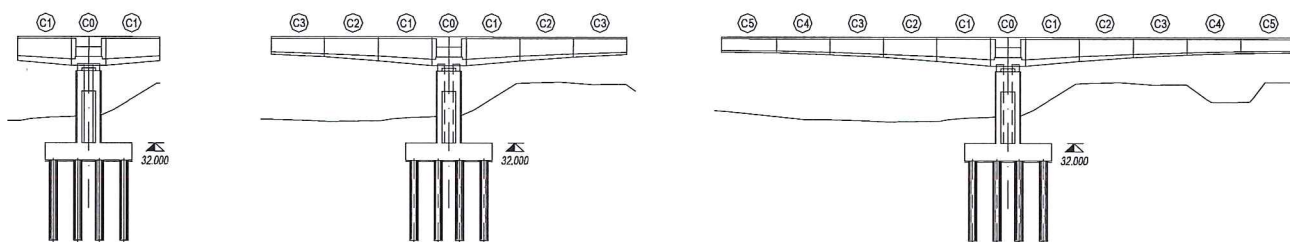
Costruzione di una stampella in avanzamento dal testapila.
